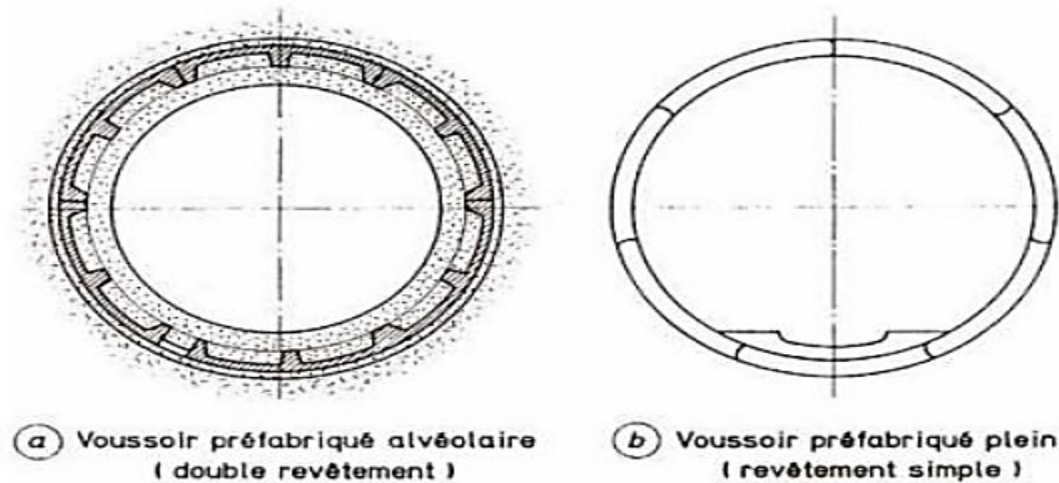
Voussoirs préfabriqués en béton armé [5]
